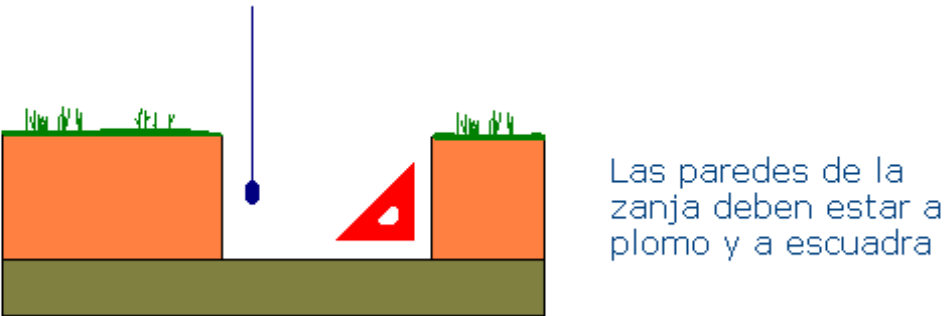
tomada de internet: www.construccionnaturalbariloche.blogspot.comexcavado zanja
